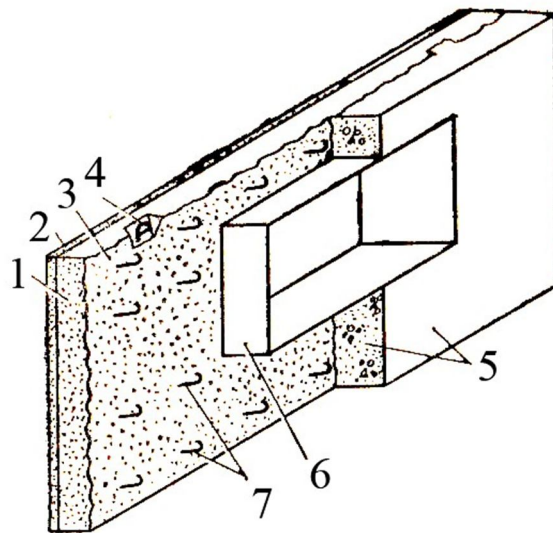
Залізобетонна нез'ємна опалубка
